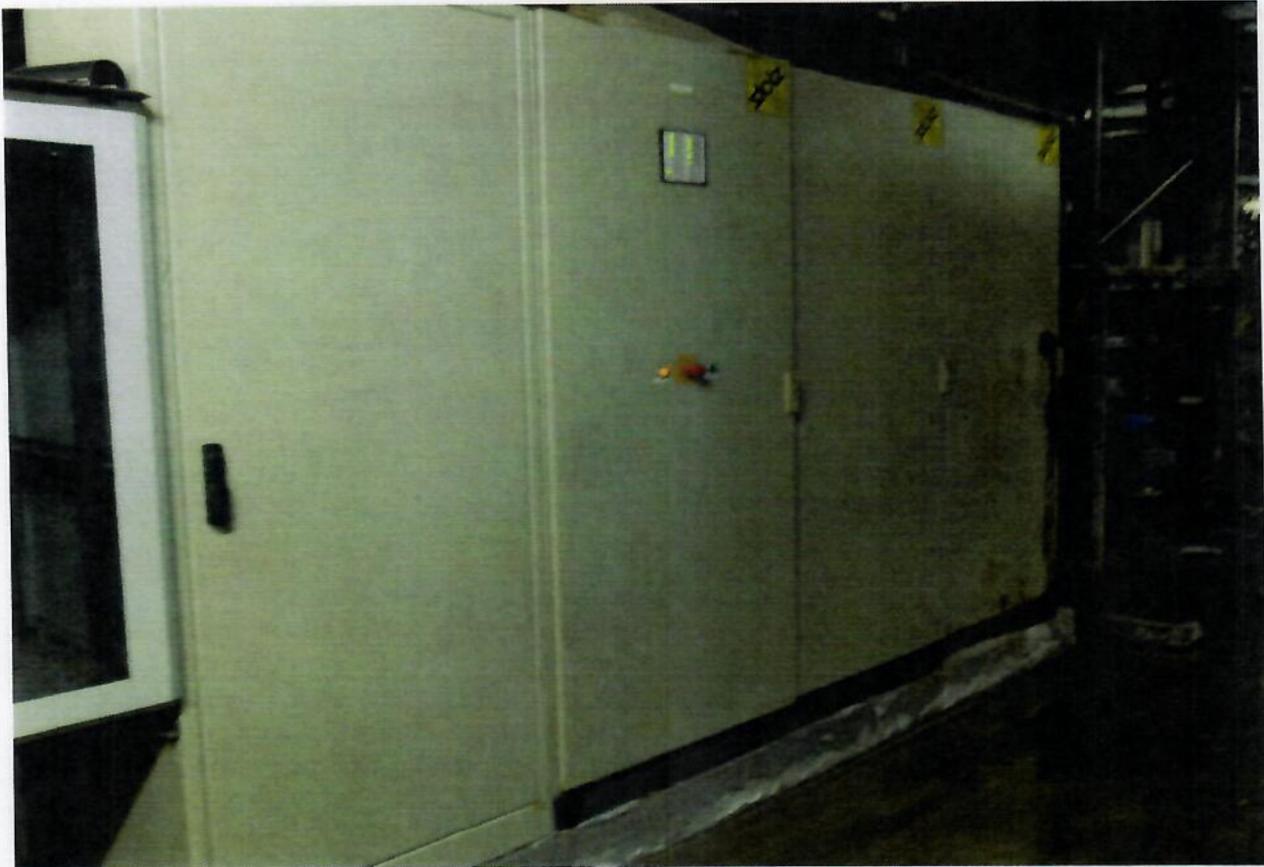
Elektro 14: Korrodierte Unterverteilung Technikraum
